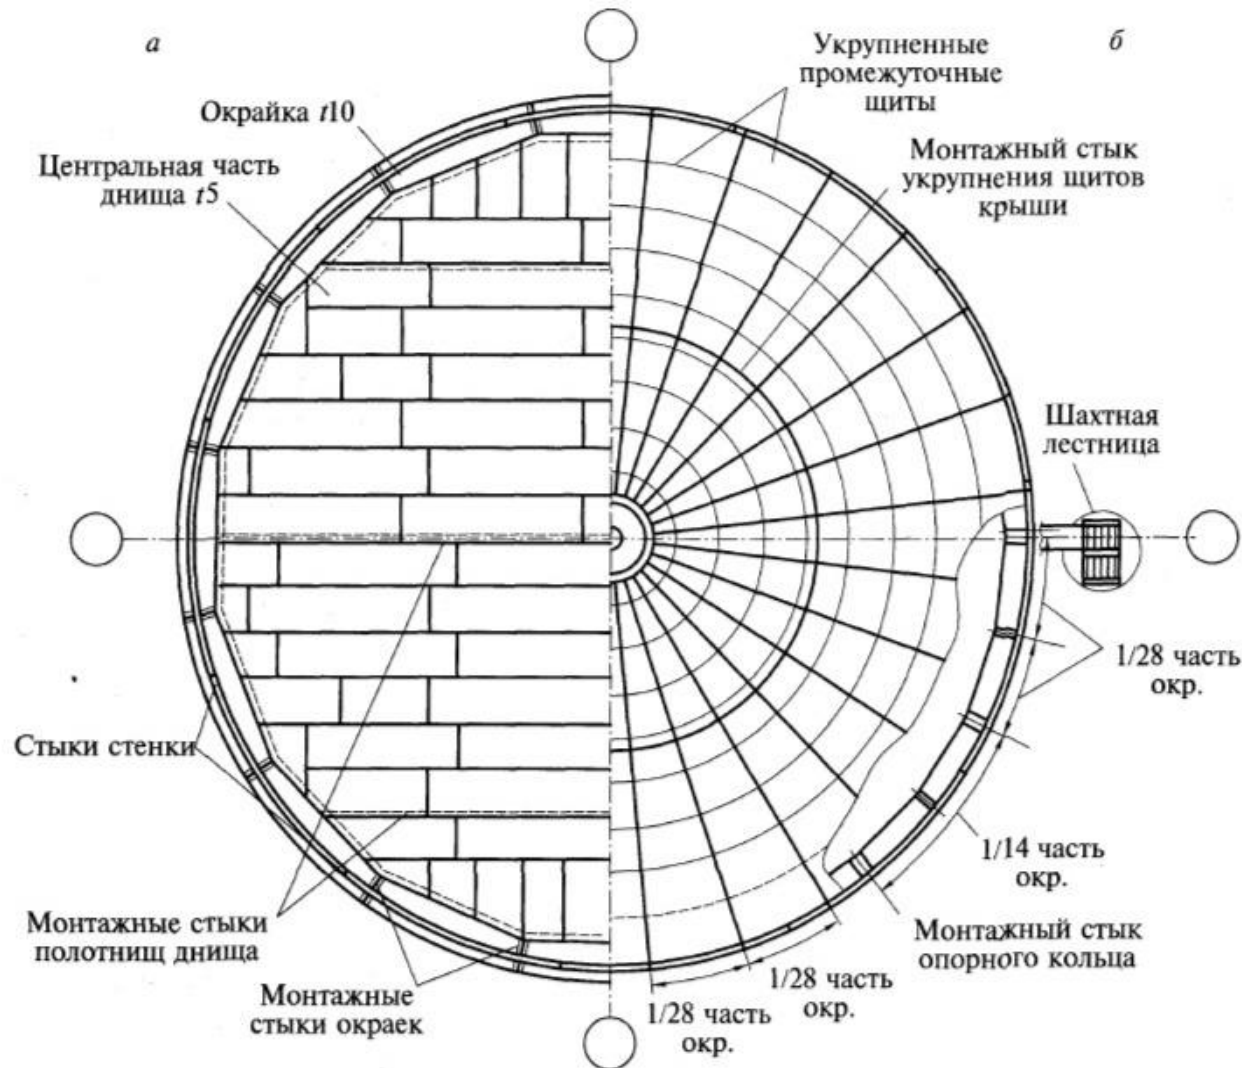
План днища (а) и стационарной крыши (б) вертикального цилиндрического резервуара
